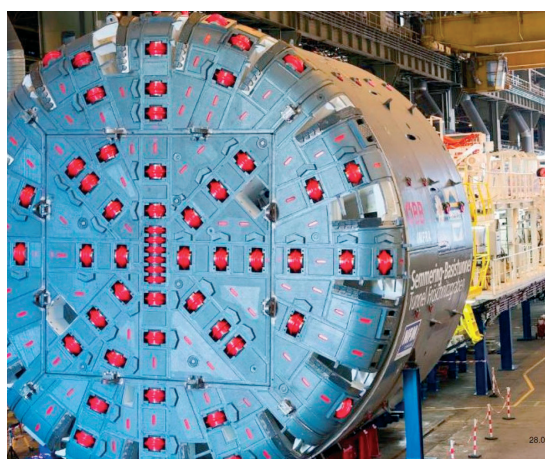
Tunnelbohrmaschine Semmering, © ÖBB
